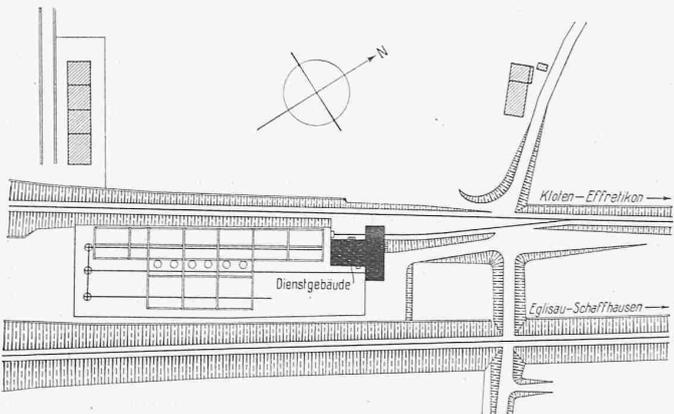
Lageplan des Freiluft-Unterwerkes Seebach. — Masstab 1 : 3000.
